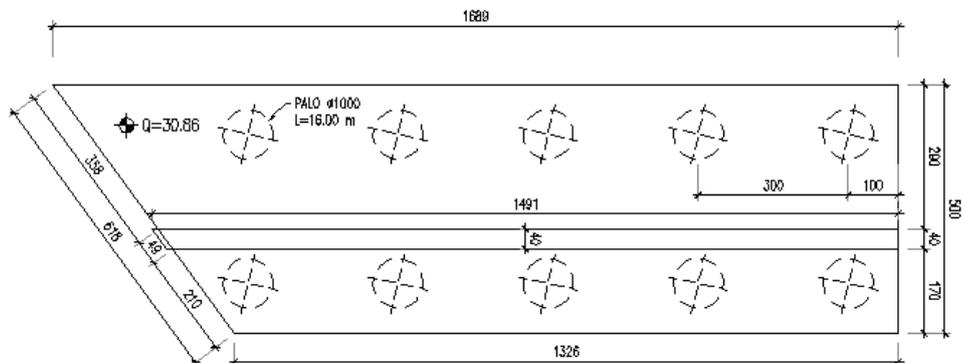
Planimetria fondazioni e prospetto muro contenimento lato Spalla 2 sx
